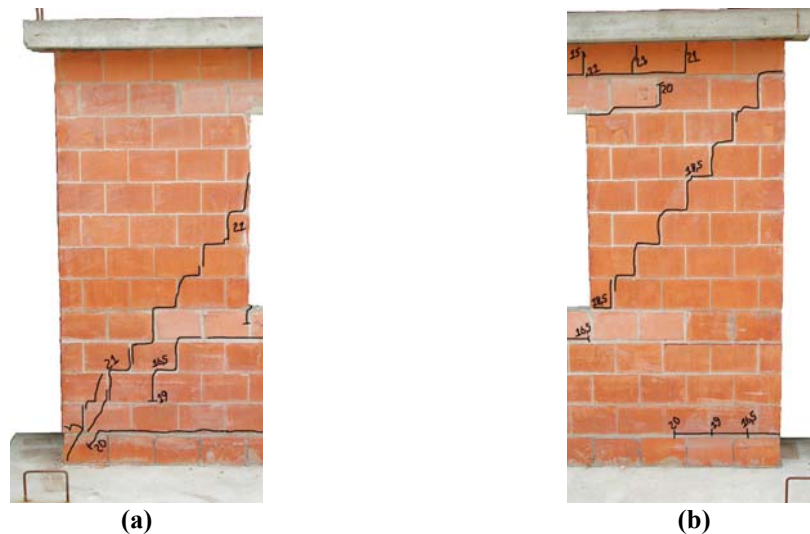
Fissuração das paredes do modelo PJS2: (a) Parede P1 e (b) Parede P2.
